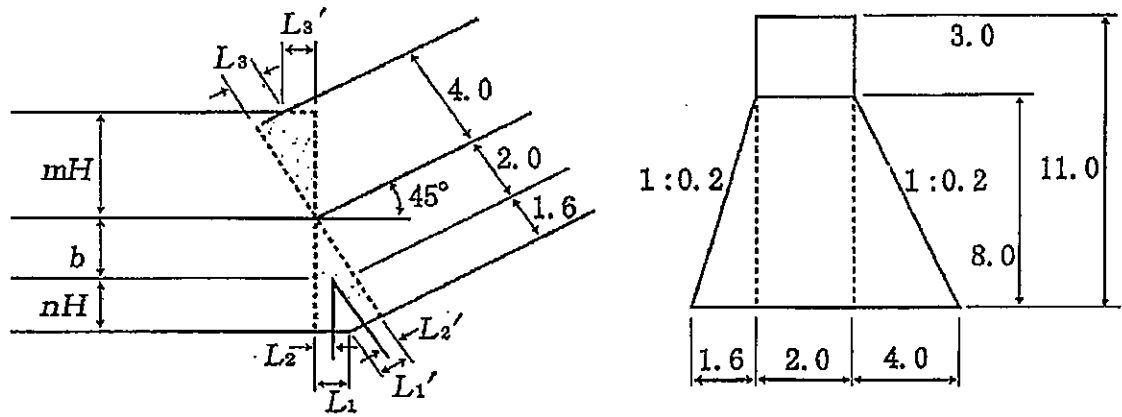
袖折れ堰堤割増しコンクリートおよび型枠の算出例
